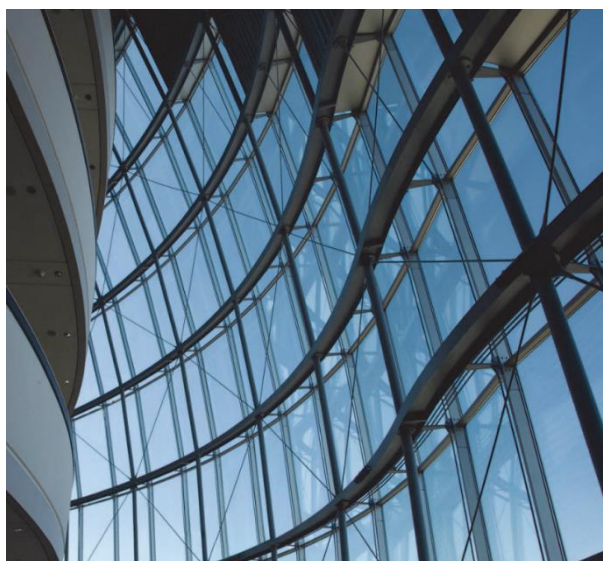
dźwigar dachowy: widok z wnętrza i na zewnątrz [5]
